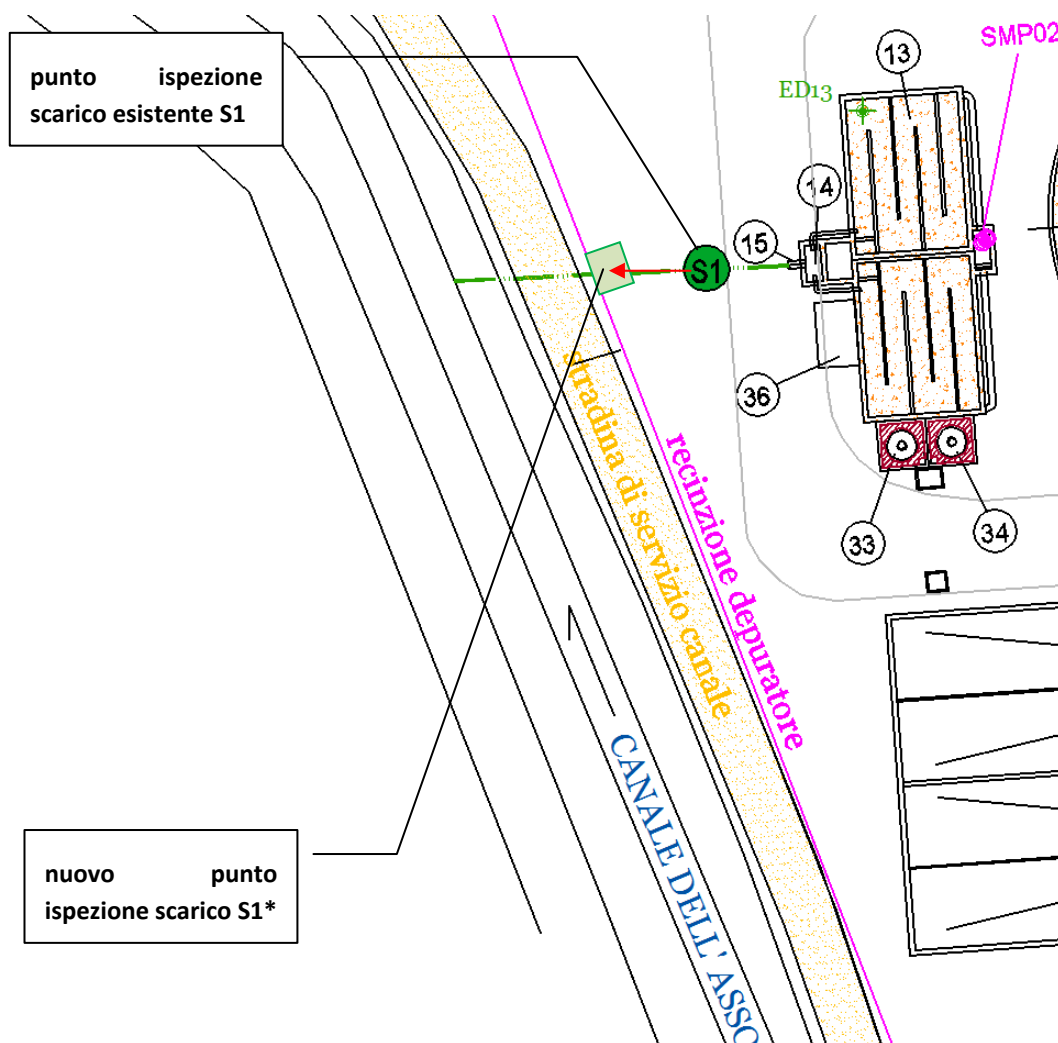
planimetria con proposta nuovo punto di ispezione scarico
